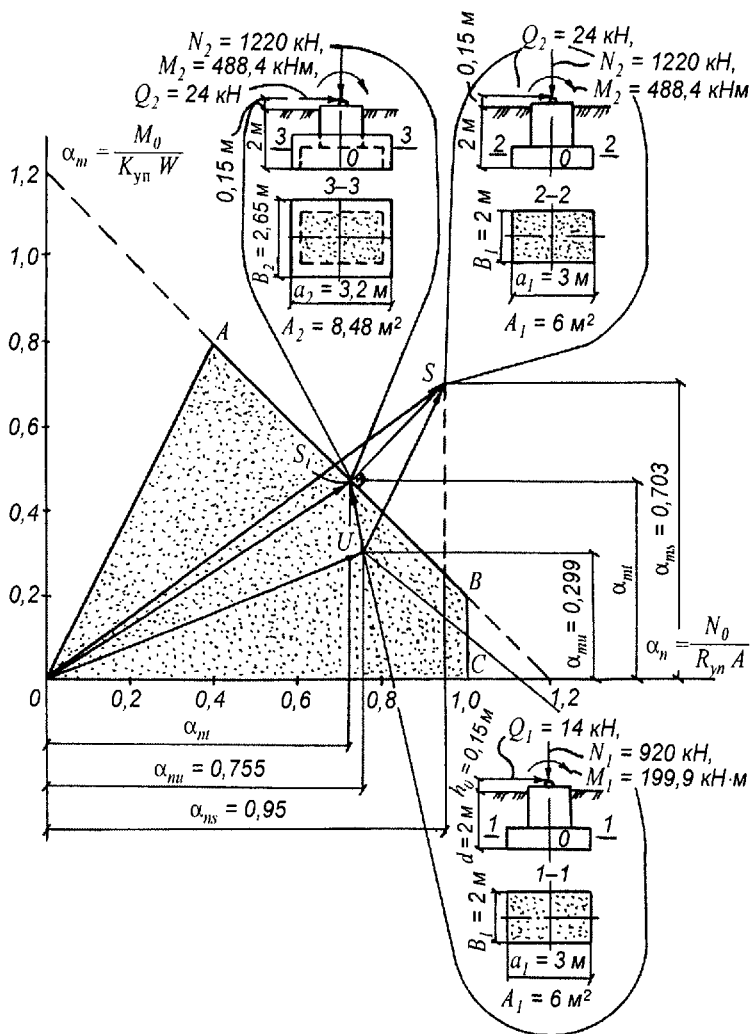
Схема к определению размеров фундамента под колонну реконструируемого здания с помощью линейной деформируемости грунтового основания
